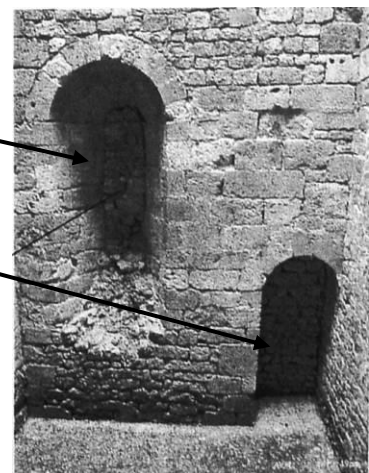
Photographie de deux baies dans le sondage n°3 : baie 7 au centre et une autre baie à droite (au droit de l'arrachement central du mur).
